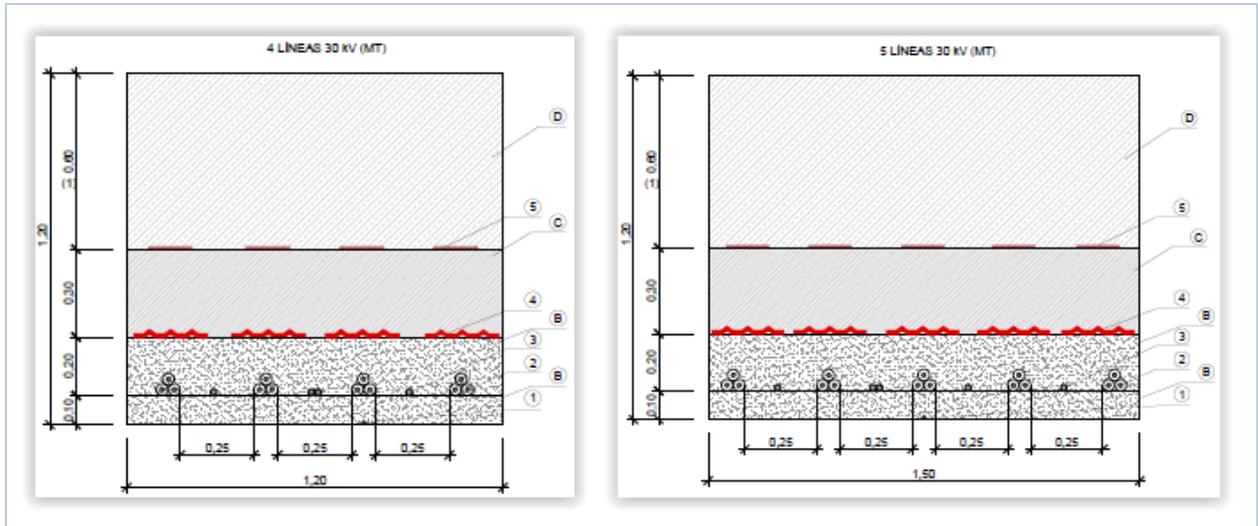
Detalle Sección Zanja. Tipo conductor directamente enterrado. (Lateral vial o por tierras) (2 de 2)
